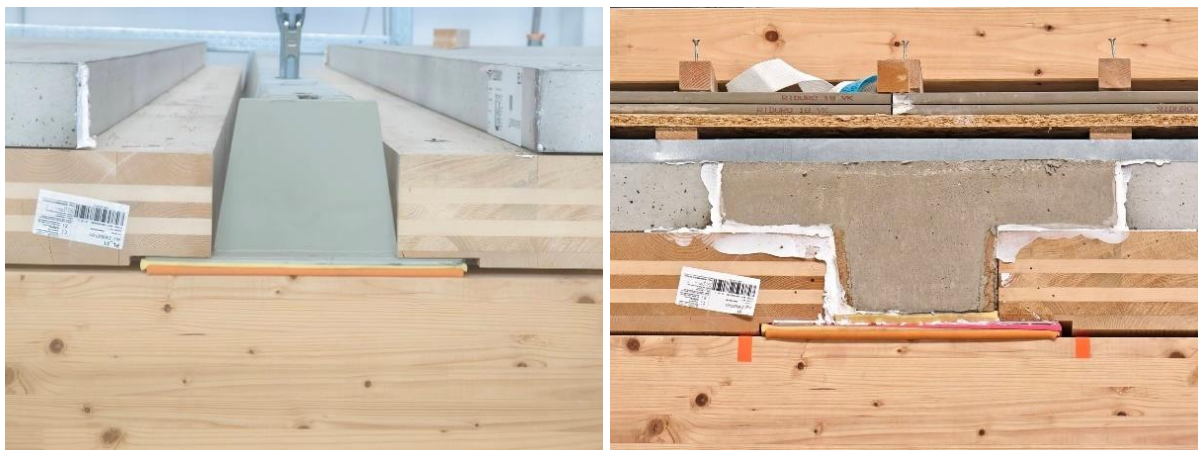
Einbauzustand des deckenebenen DELTABEAM® Verbundträgers als Deckenaufleger einer Holz-Beton-Verbunddecke (100 mm Beton, 140 mm CLT). Links ist der Zustand des nicht ausbetonierten Trägers dargestellt, rechts der Zustand nach dem Ausbetonieren.
